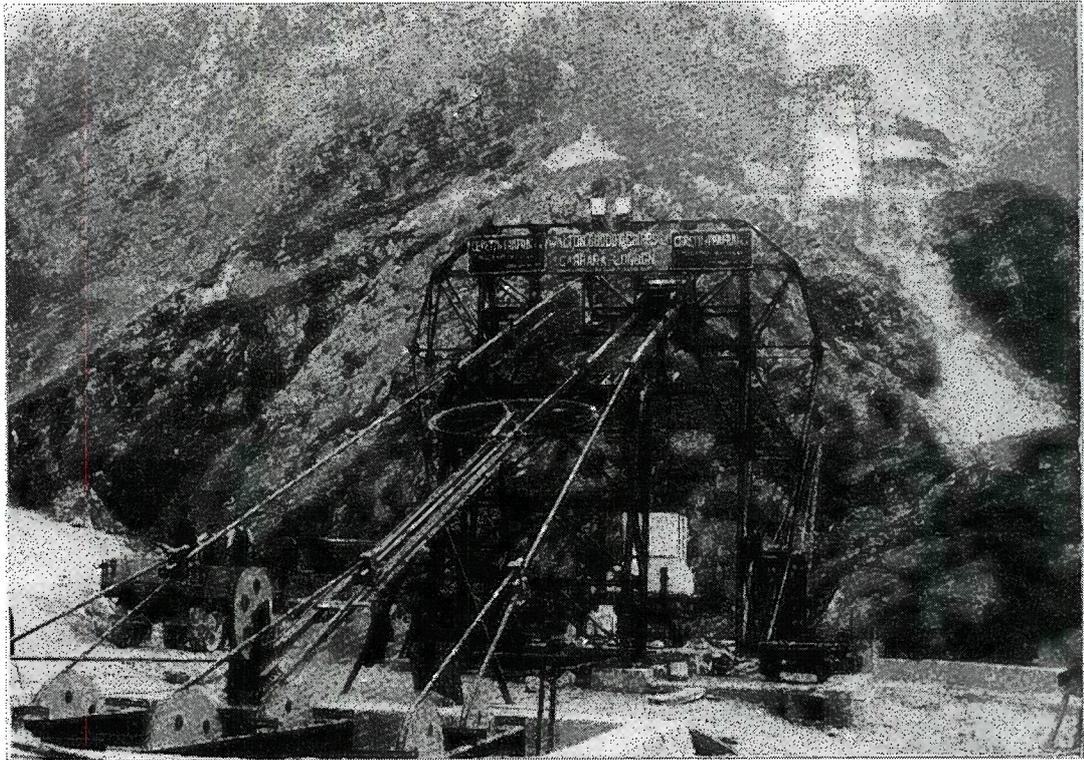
Particolare della stazione inferiore della Teleferica del Balzone
